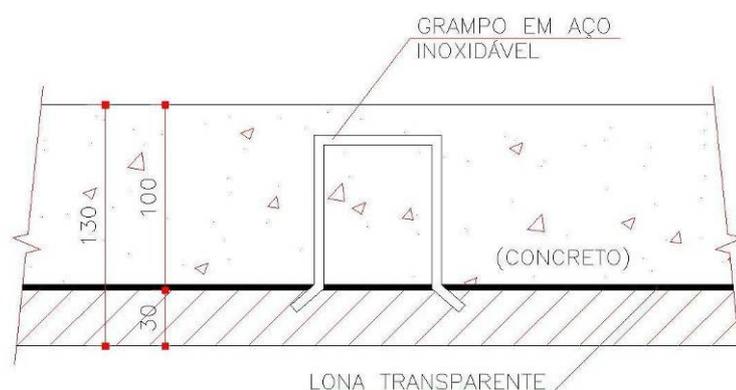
Detalhe da ancoragem de fixação do granito no painel pré-moldado de concreto
